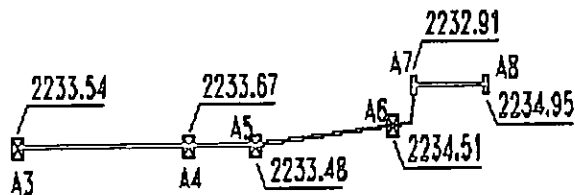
Vista en planta del Puente Peatonal No. 3 "Calle Uno",
